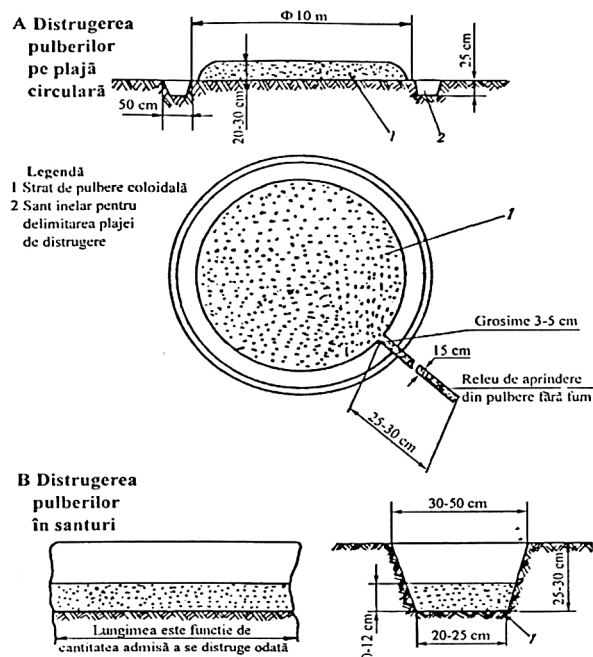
Plajă de distrugere prin ardere a pulberilor
